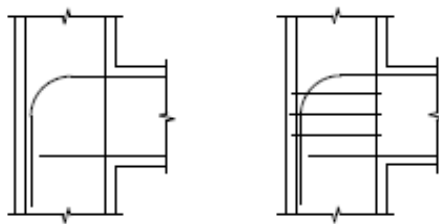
Pormenorização da armadura das ligações viga-pilar (Sarsam, 1983)
